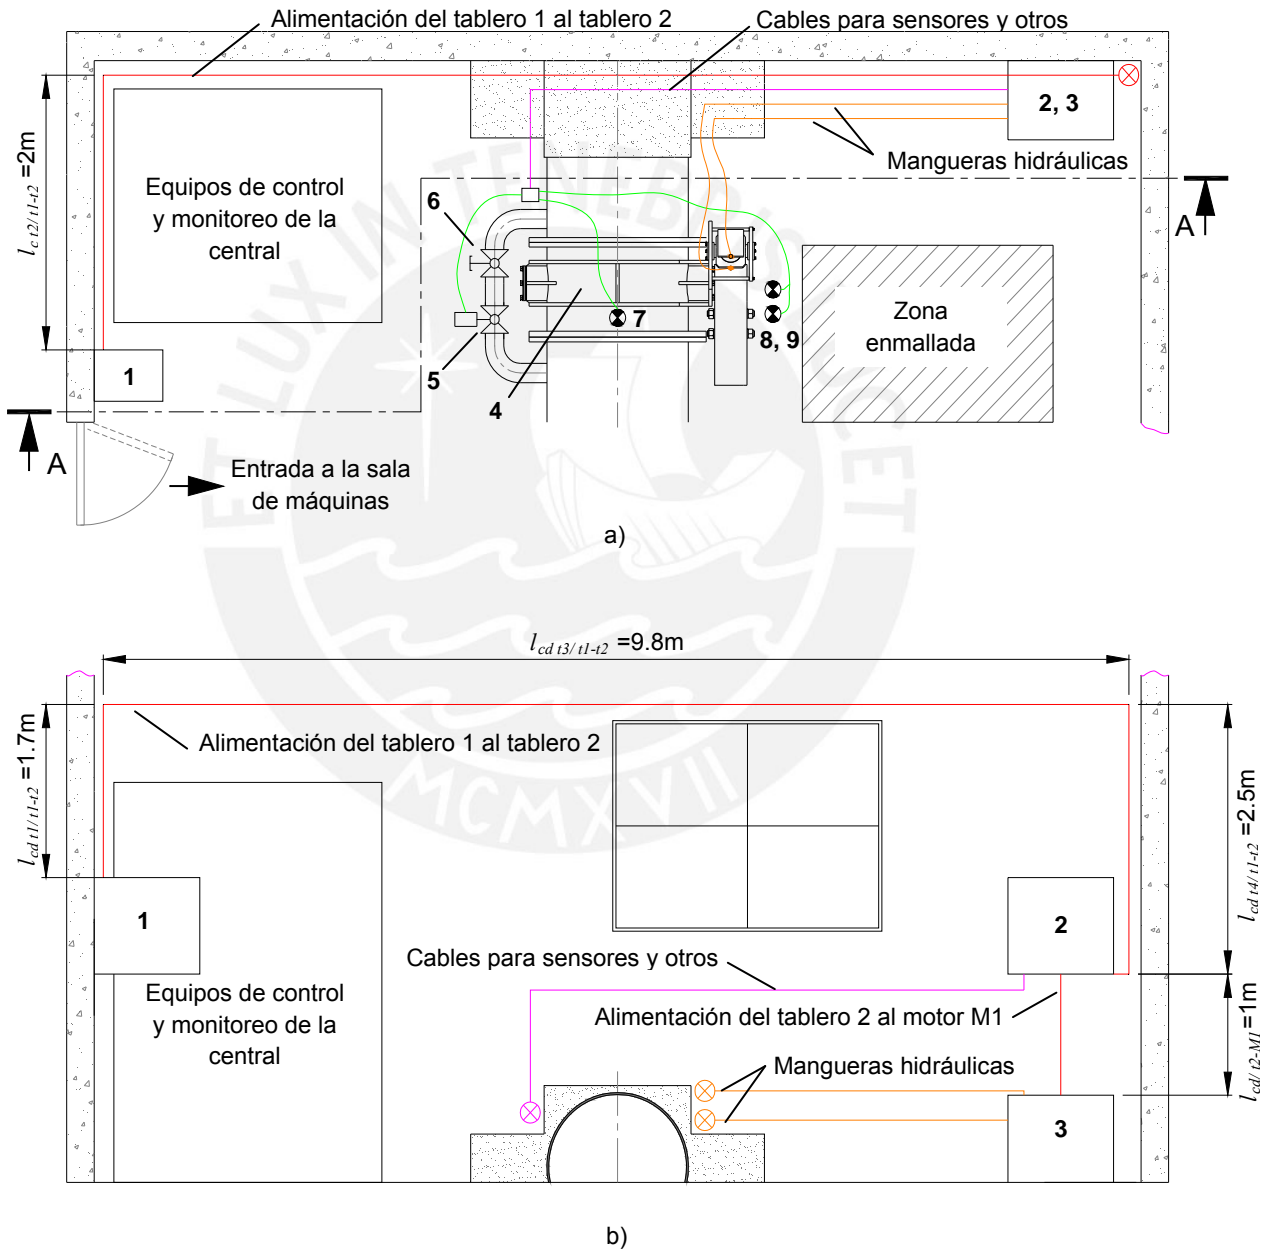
Disposición de tableros y equipos en la sala de máquinas a) Vista de planta b) Vista de corte A-A [Elaboración propia]
